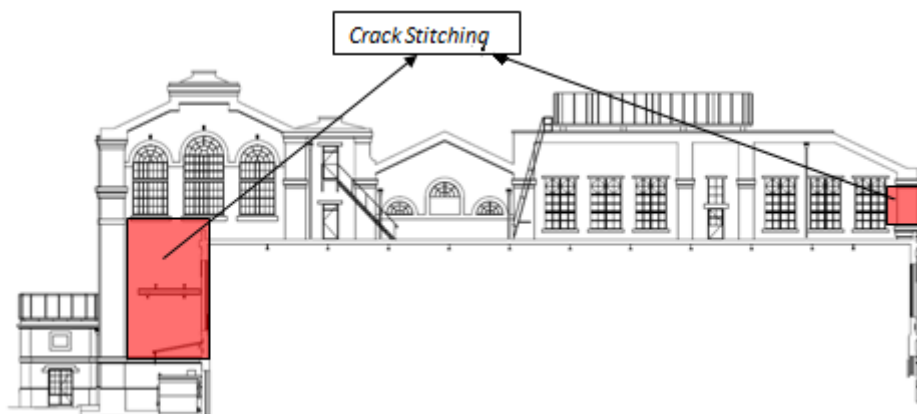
Zona de grampeamento de fissuras. Fachada Nascente da BP.
